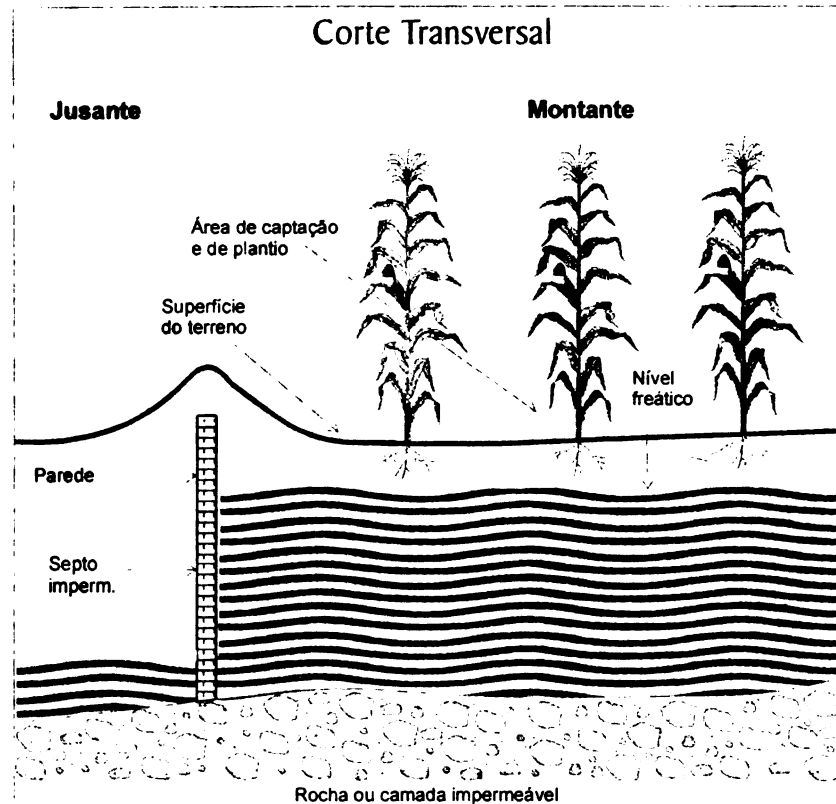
Desenho esquemático de exploração de barragem subterrânea.
